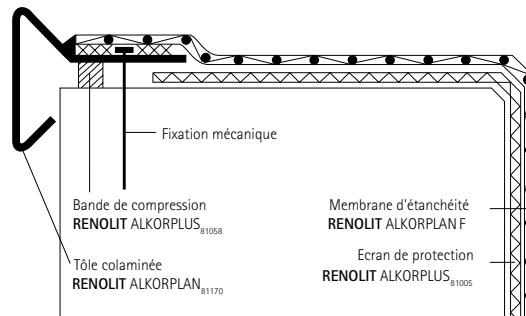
Etanchéité au vent par pose en indépendance d'autres membranes RENOLIT ALKORPLAN.
